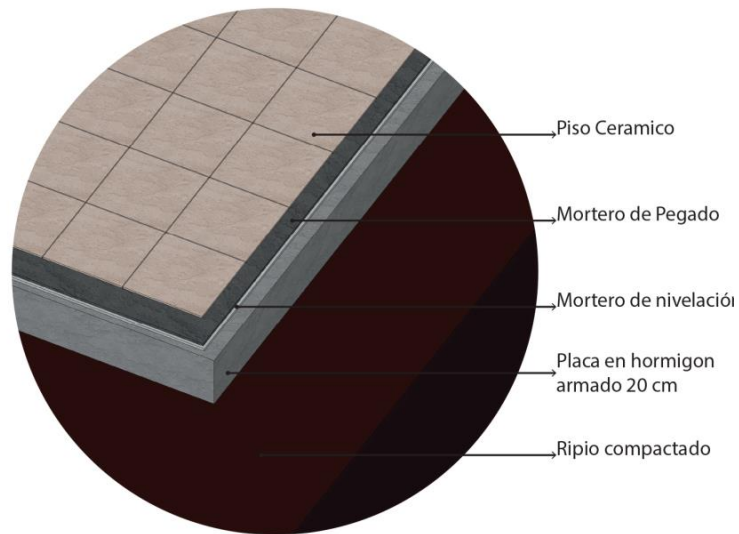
Detalle constructivo típico de placa de contra piso Fuente: elaboración propia
